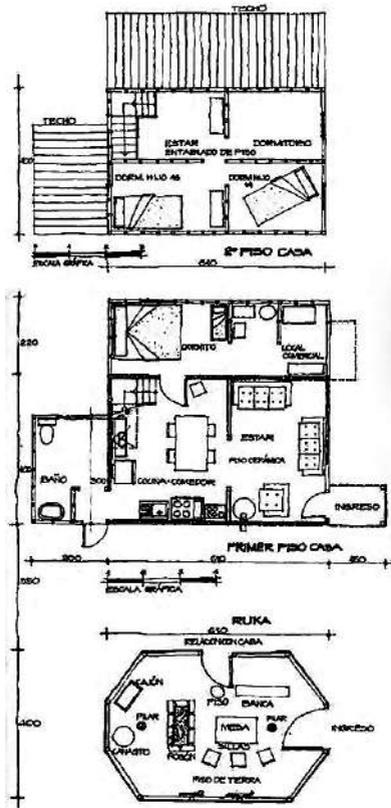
Levantamiento planimétrico visual aproximado del primer y segundo piso de vivienda típica existente de la IX Región (foto en figura 3), autoconstruida por el matrimonio hace 15 años. En el primer piso aparece la planimetría de la ruca. Fuente: Levantamiento y dibujo elaboración propia.
